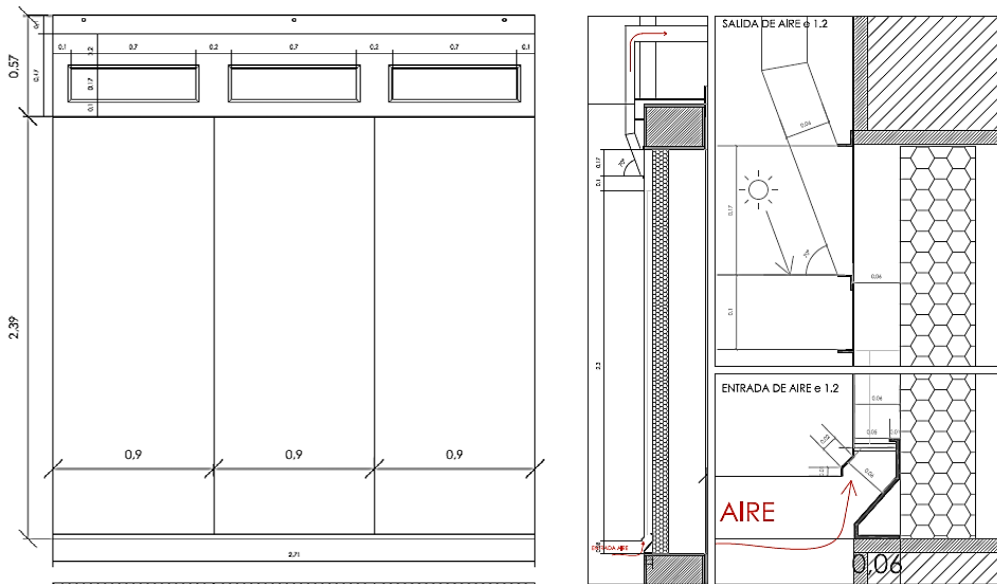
Planos constructivos del prototipo de ensayo de una fachada ventilada forzada
